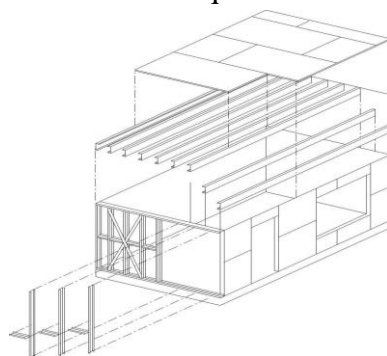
Construção “Stick-Build” (Grubb *et al.*, 2001).
